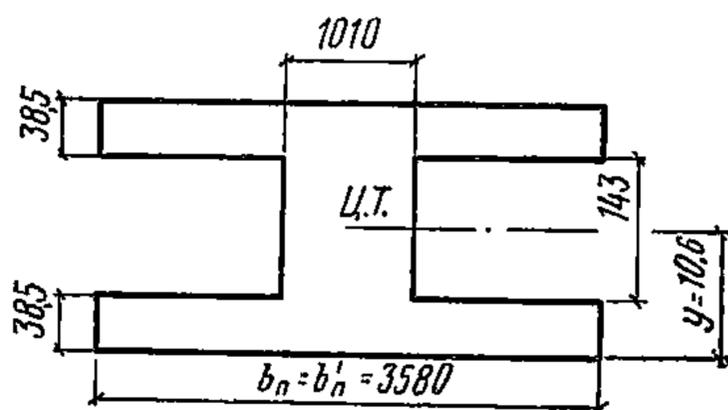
Расчетное эквивалентное сечение панели (для расчета по второй группе предельных состояний)
